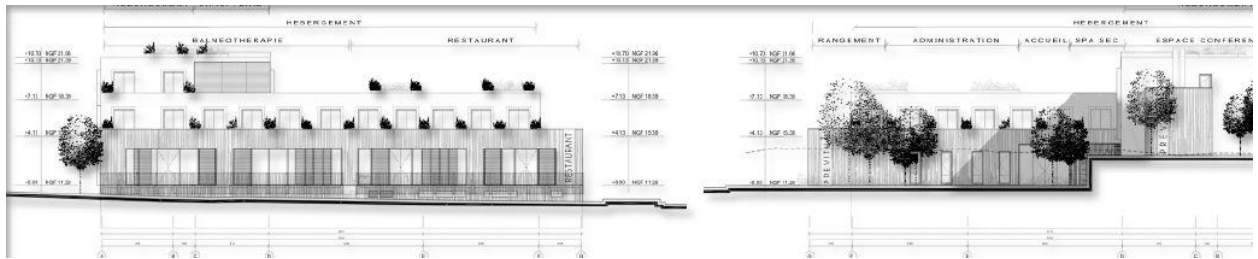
Façade ouest du centre de thalassothérapie Donville-les-bains
